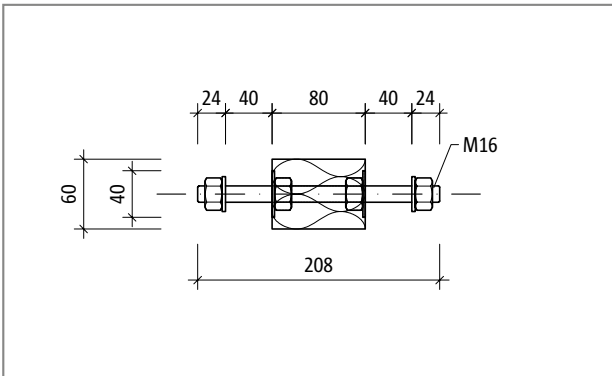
Schöck Isokorb® T Typ S-N-D16: Produktschnitt
